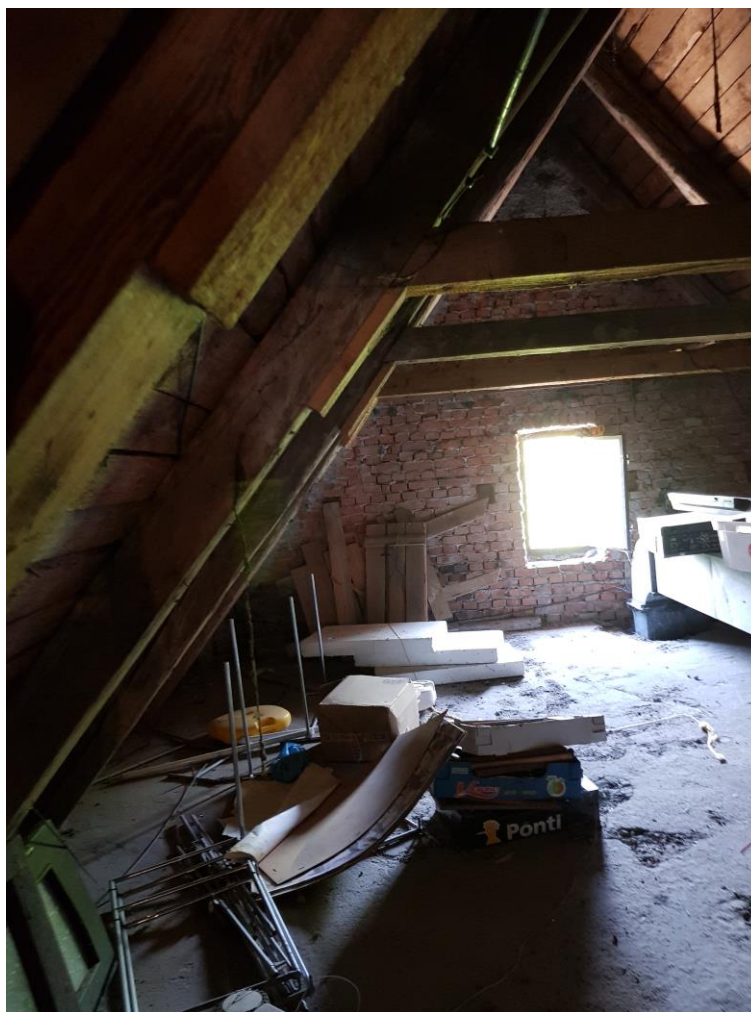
Widok z wnętrza na poszycie dachu.
